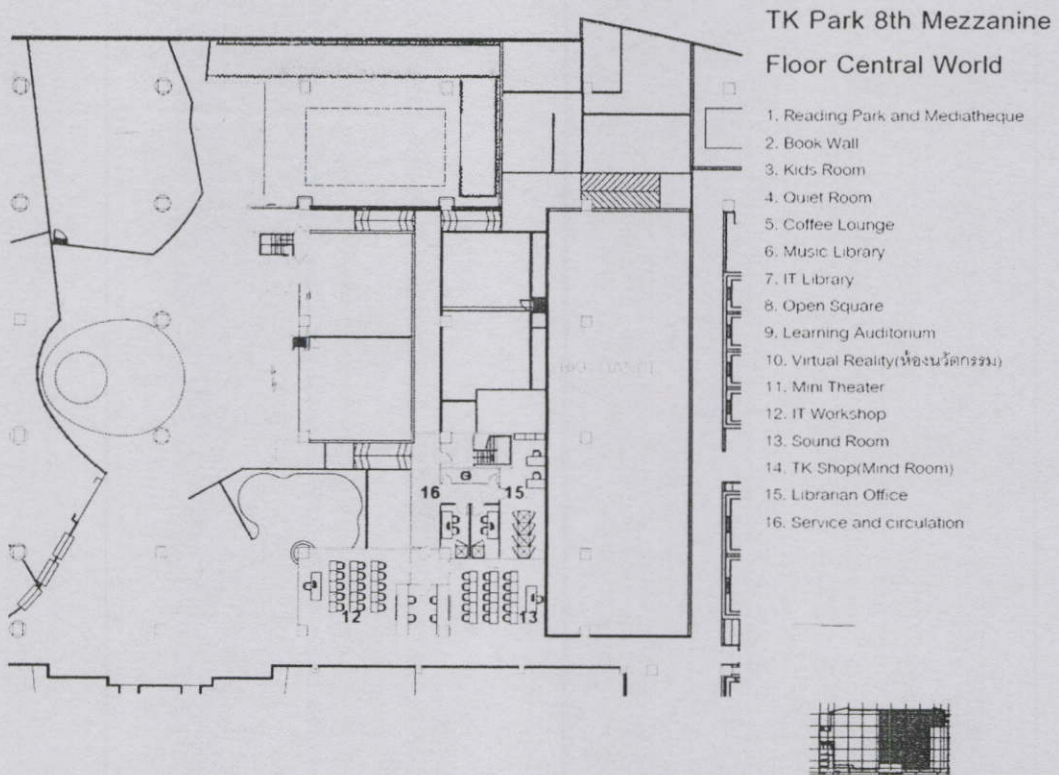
ผังโครงการอุทยานการเรียนรู้ TK Park
